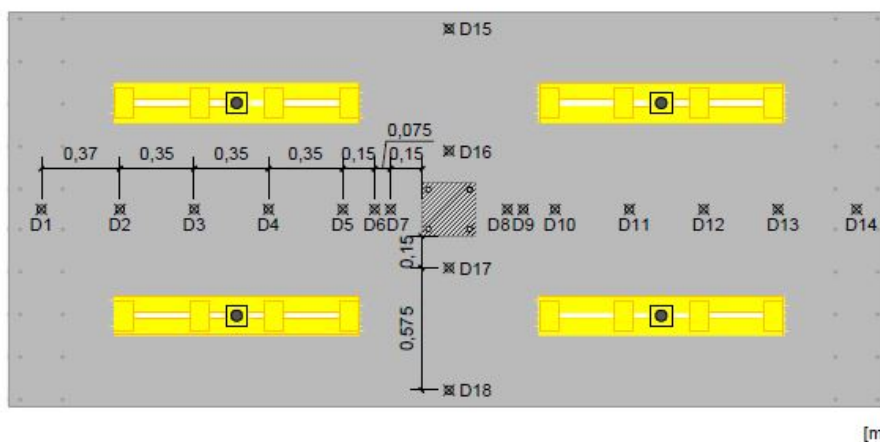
Posição dos defletómetros verticais (adaptado de [12])
